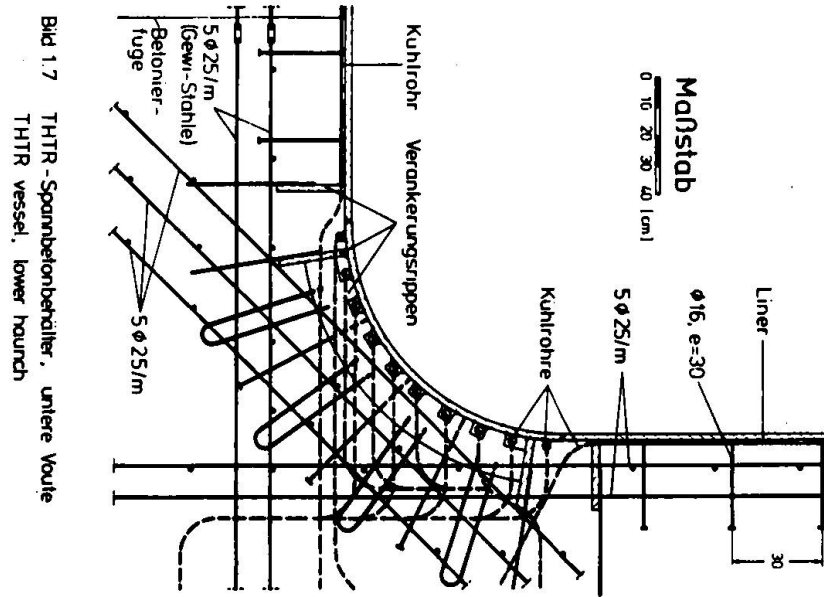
THTR-Spannbetonbehälter, untere Youite
